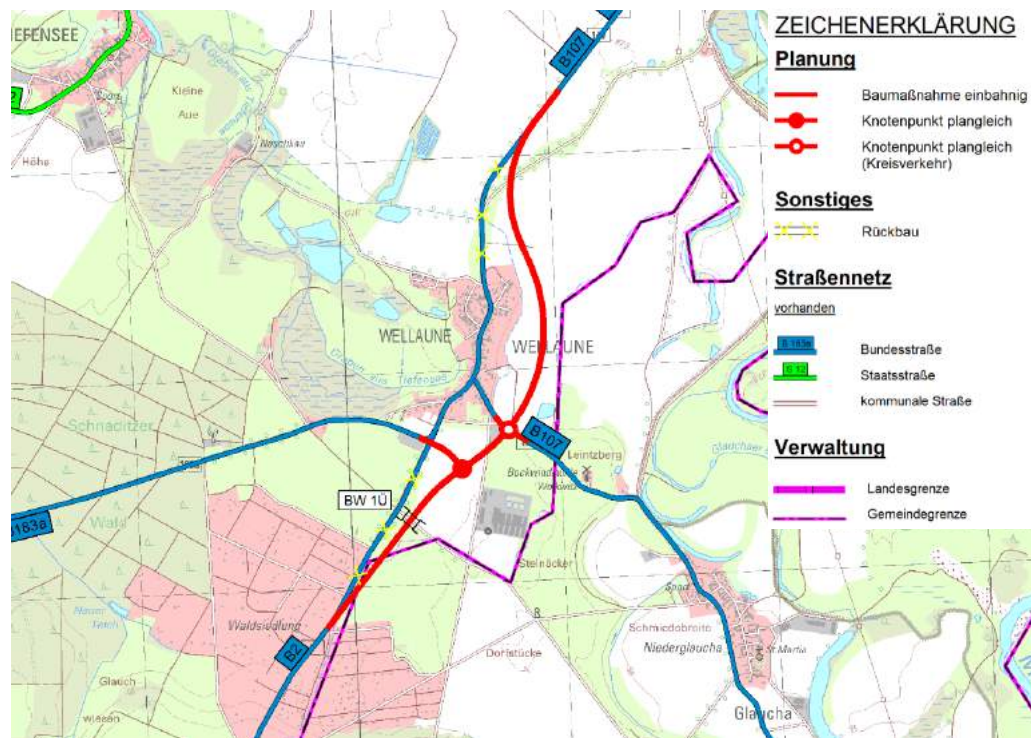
Ortsumfahrung Wellaune⁶⁸
